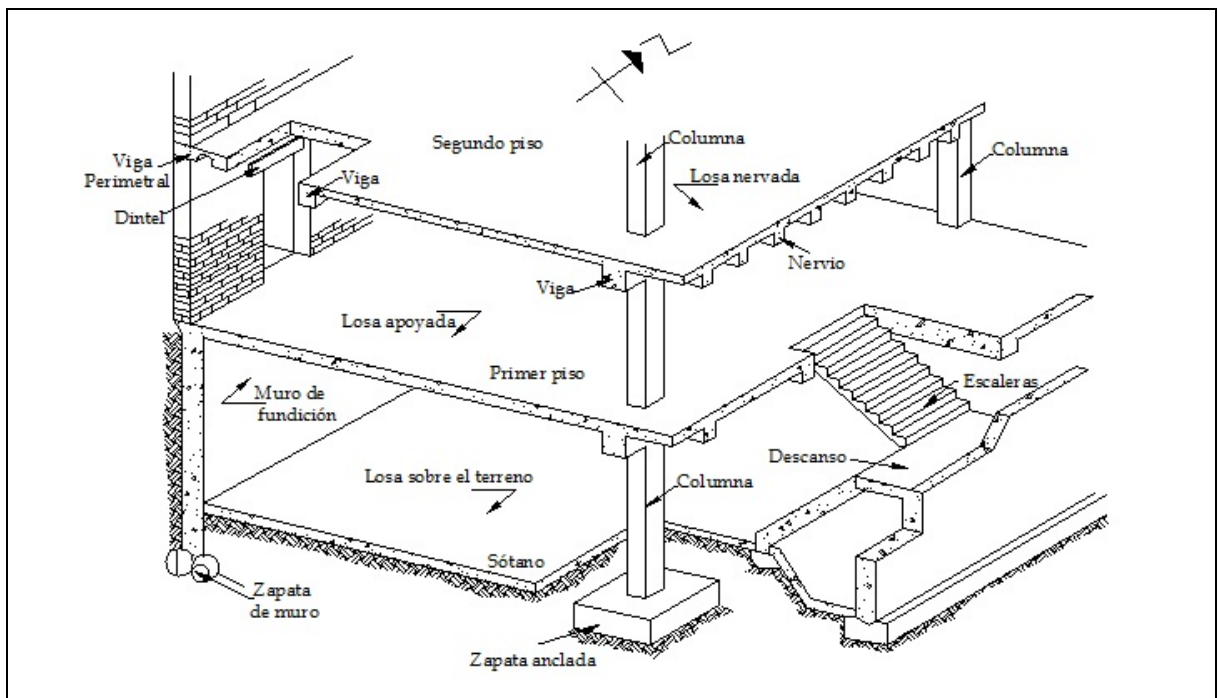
Elementos de una estructura de concreto reforzado.
